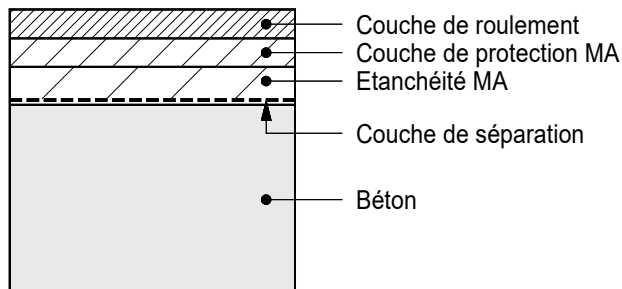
Schéma de la structure des systèmes d'étanchéité flottante
